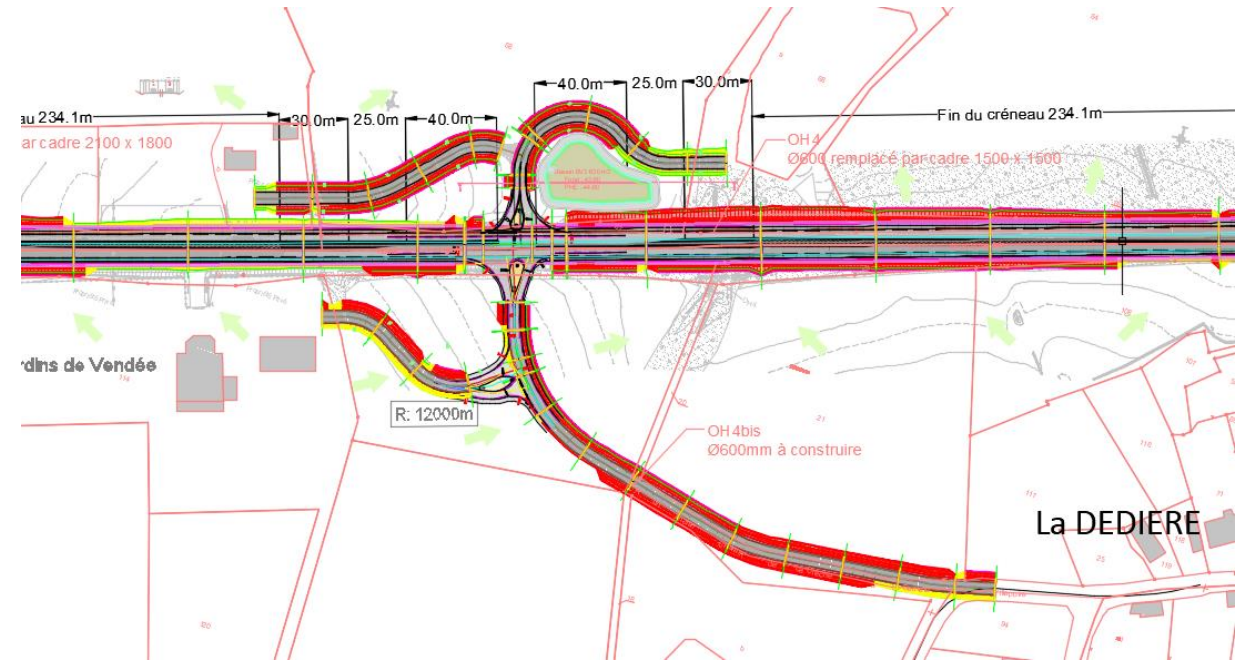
Plan du carrefour de la Dédrière - Section 1
